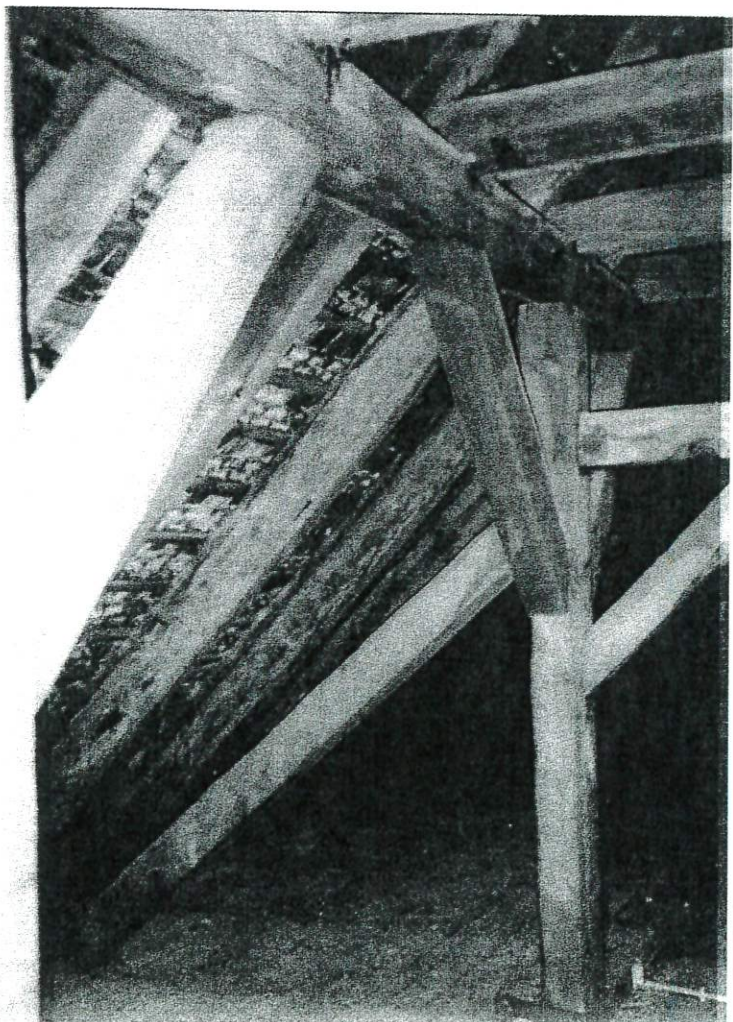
wieżba dachowa ,widok na węzeł
